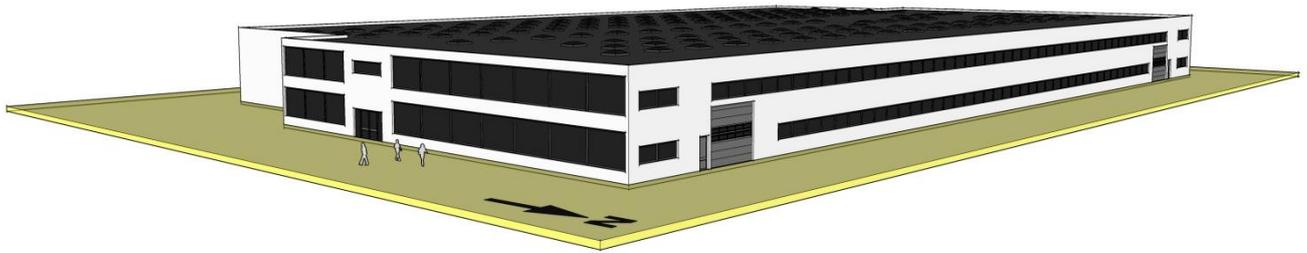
Produktionshallen - groß - Darstellung Gebäude - Ansicht Nord-Ost
